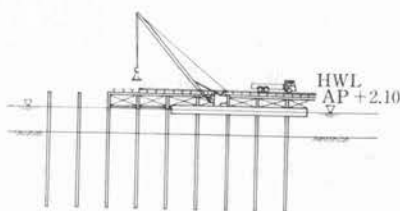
(B) 施工順序(ニューマチックケーソン基礎および橋脚施工)
